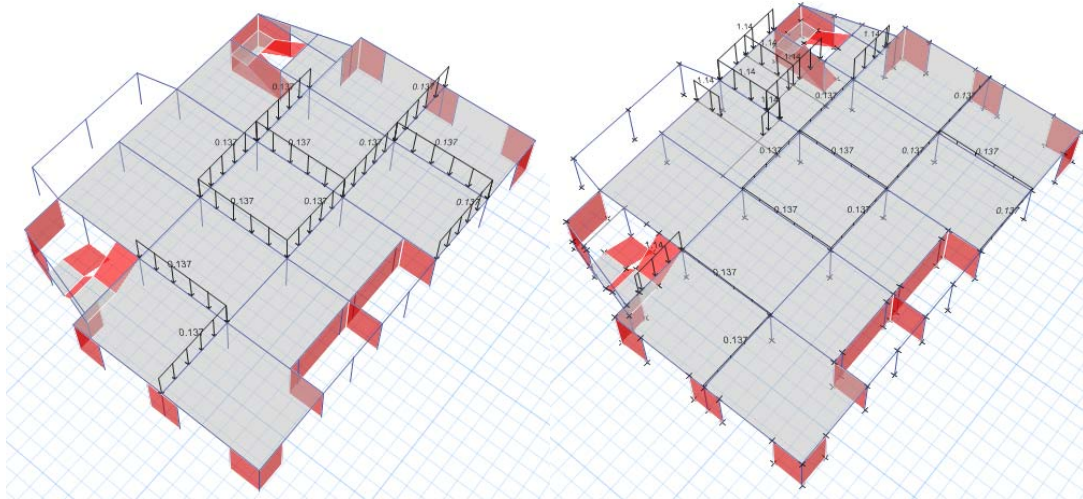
Aplicación de cargas lineales de los muros de drywall y el ladrillo.
